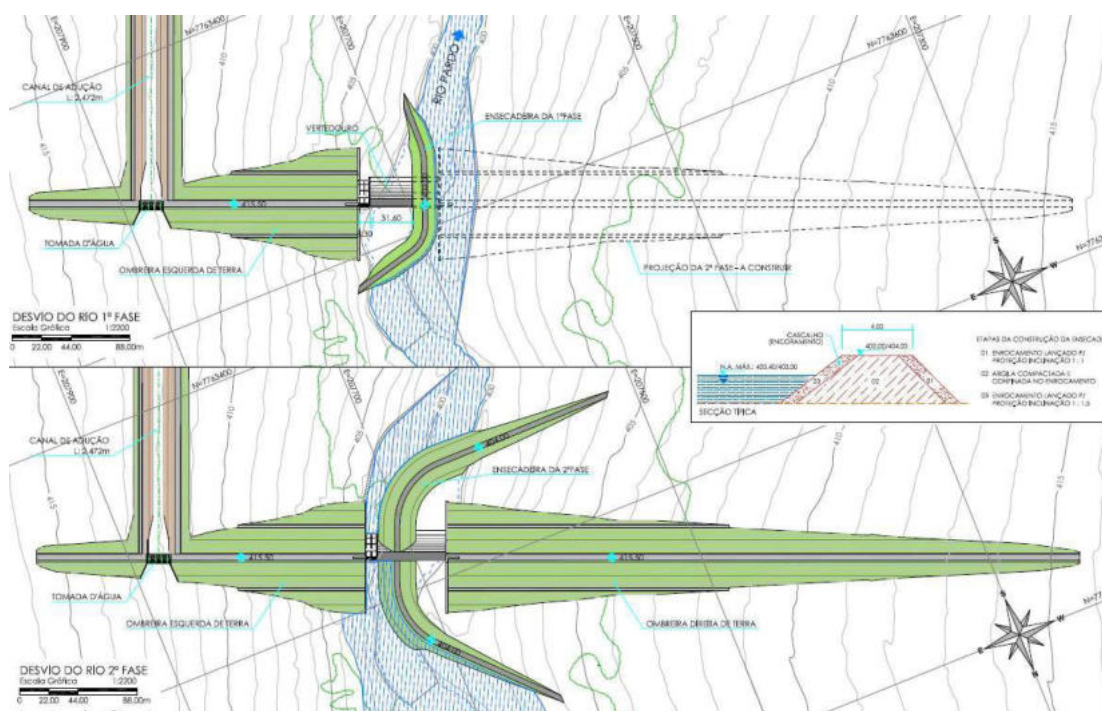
Croqui das etapas de desvio do rio Parda para implantação do barramento.
